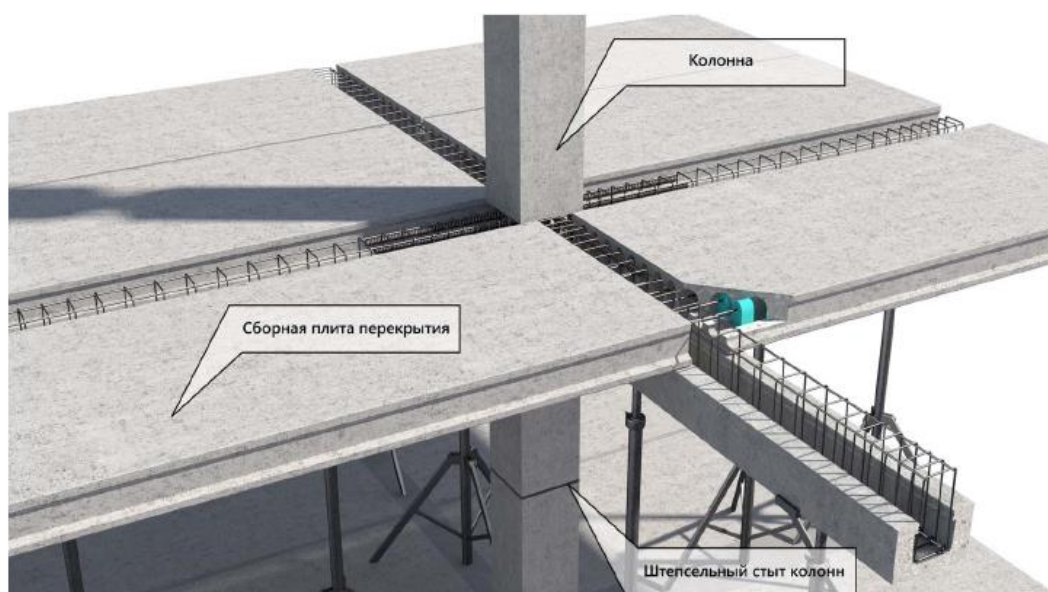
Общий вид на конструкции каркаса домостроительной системы УДС конструктивной серии СМК-18
